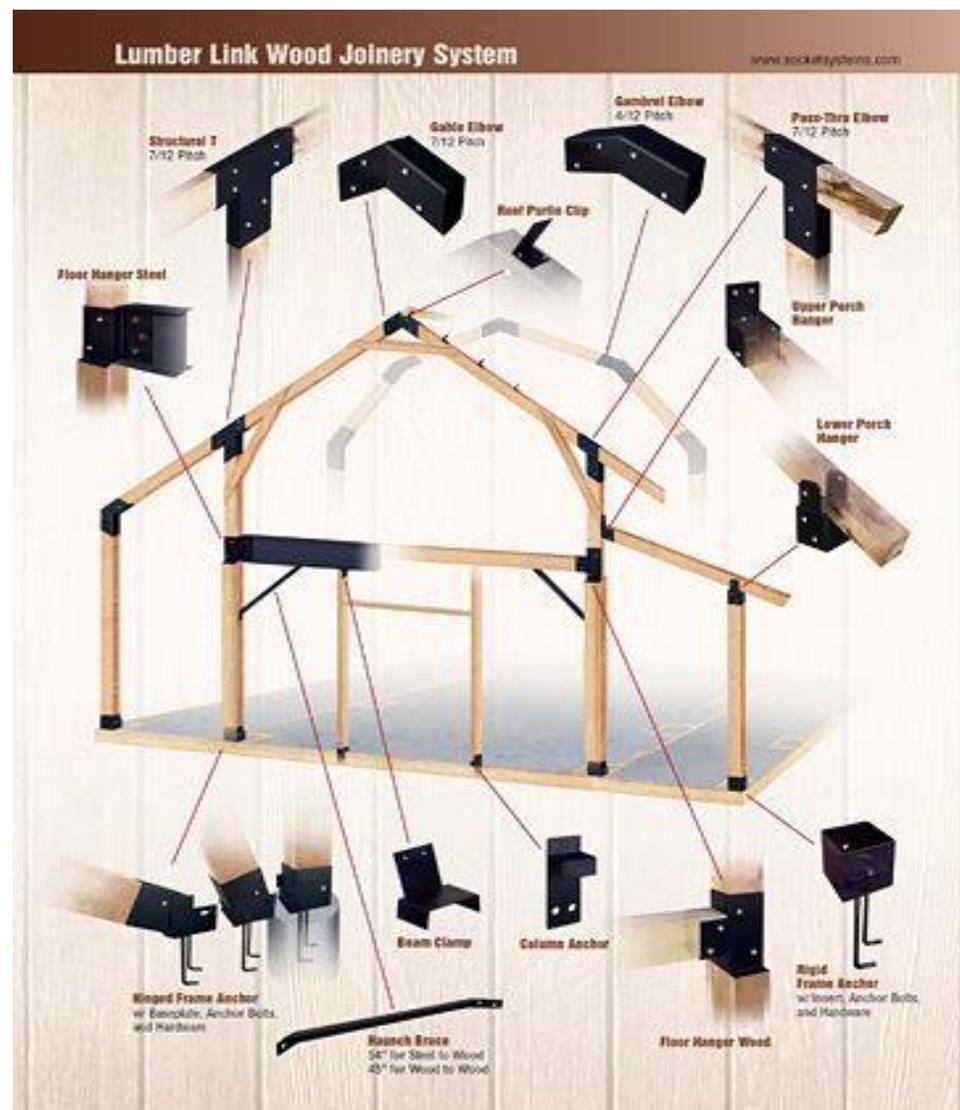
Representação técnica de detalhe construtivo de encaixes ferro madeira
